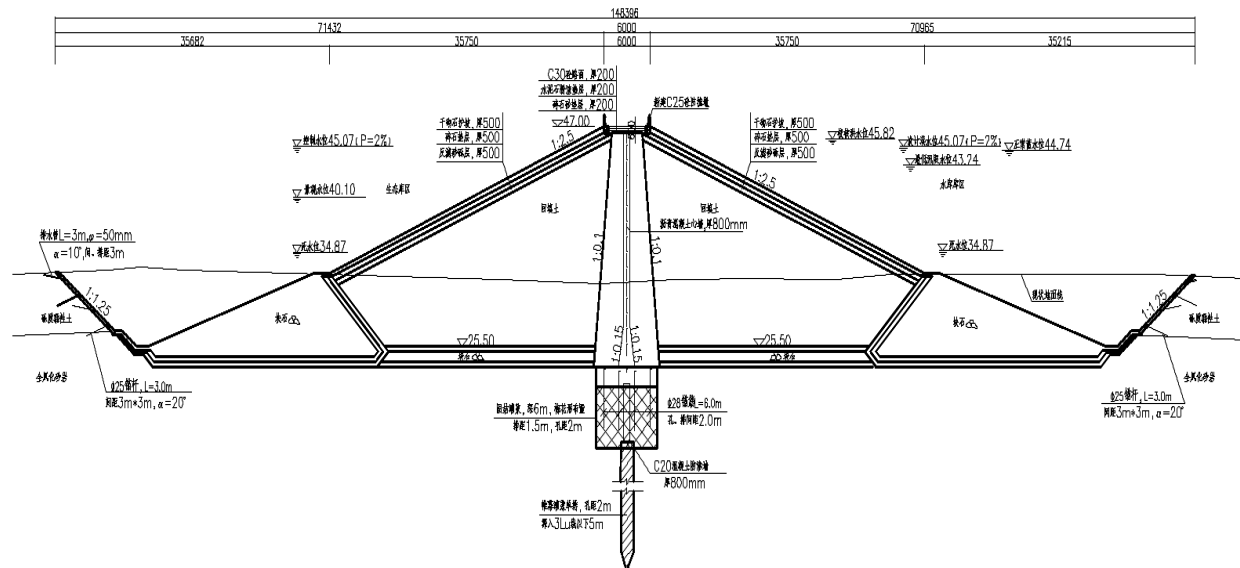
沥青混凝土心墙坝典型横剖面图
